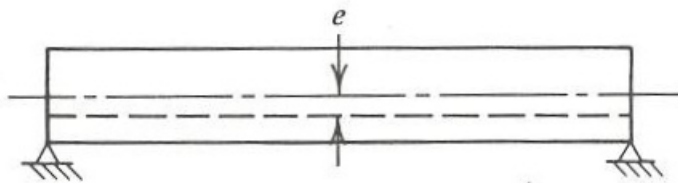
Viga con cables preesforzados con excentricidad constante
